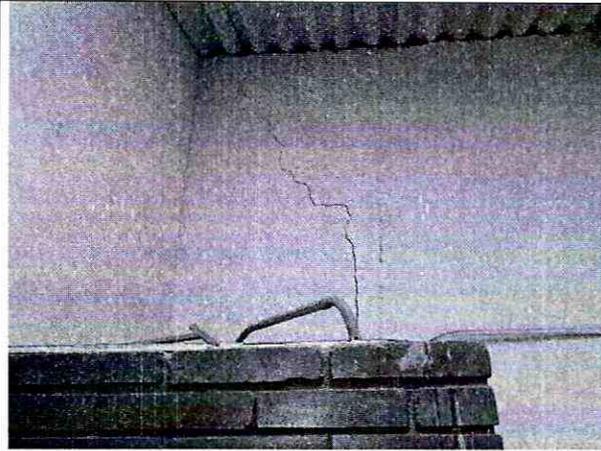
Agrietamiento en muro del segundo piso.
